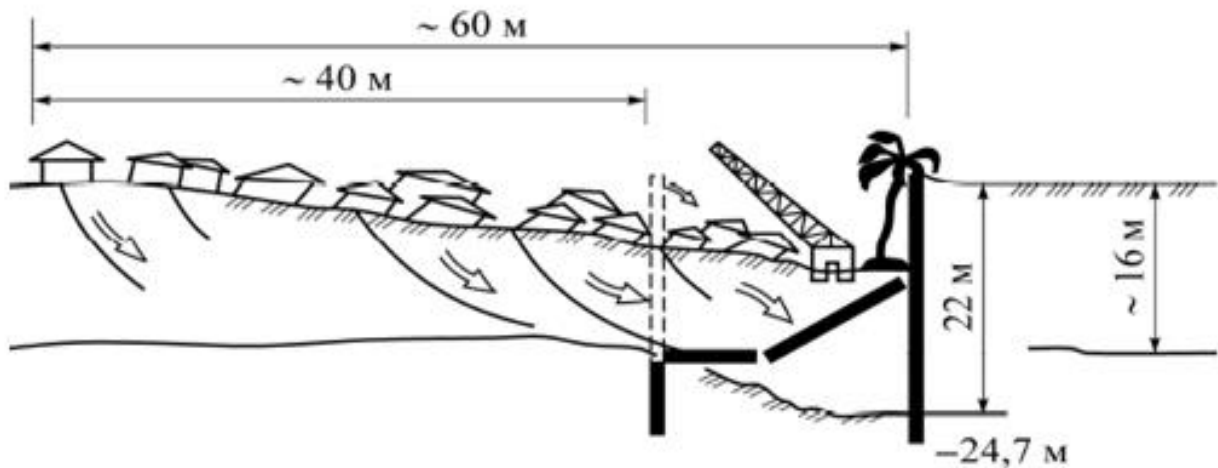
Схема зони прояву наслідків аварії котловану насосної станції
